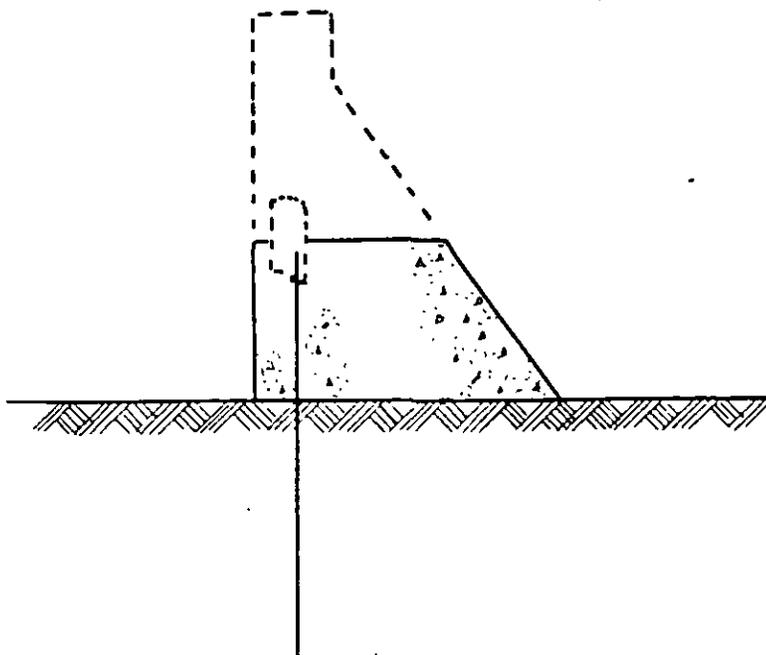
Inyección desde la galería de la presa parcialmente construída.
